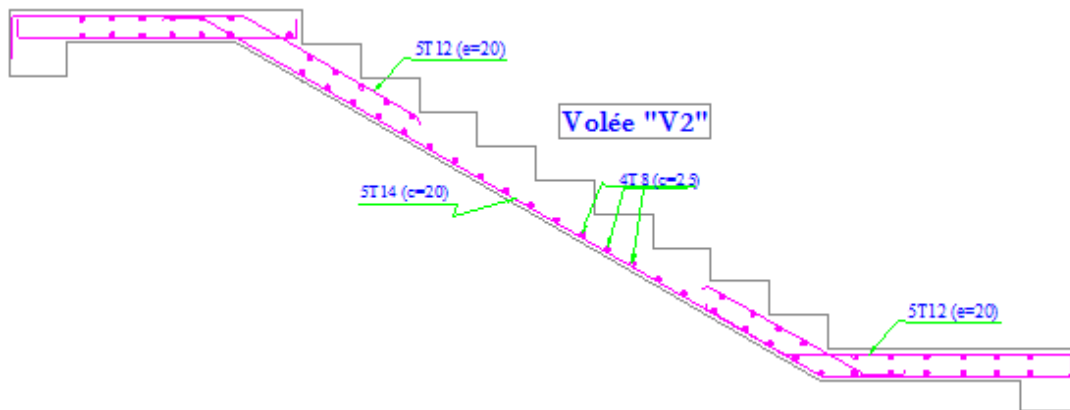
Ferrailage de la volée 2 d'escalier de RDC (type 1).
